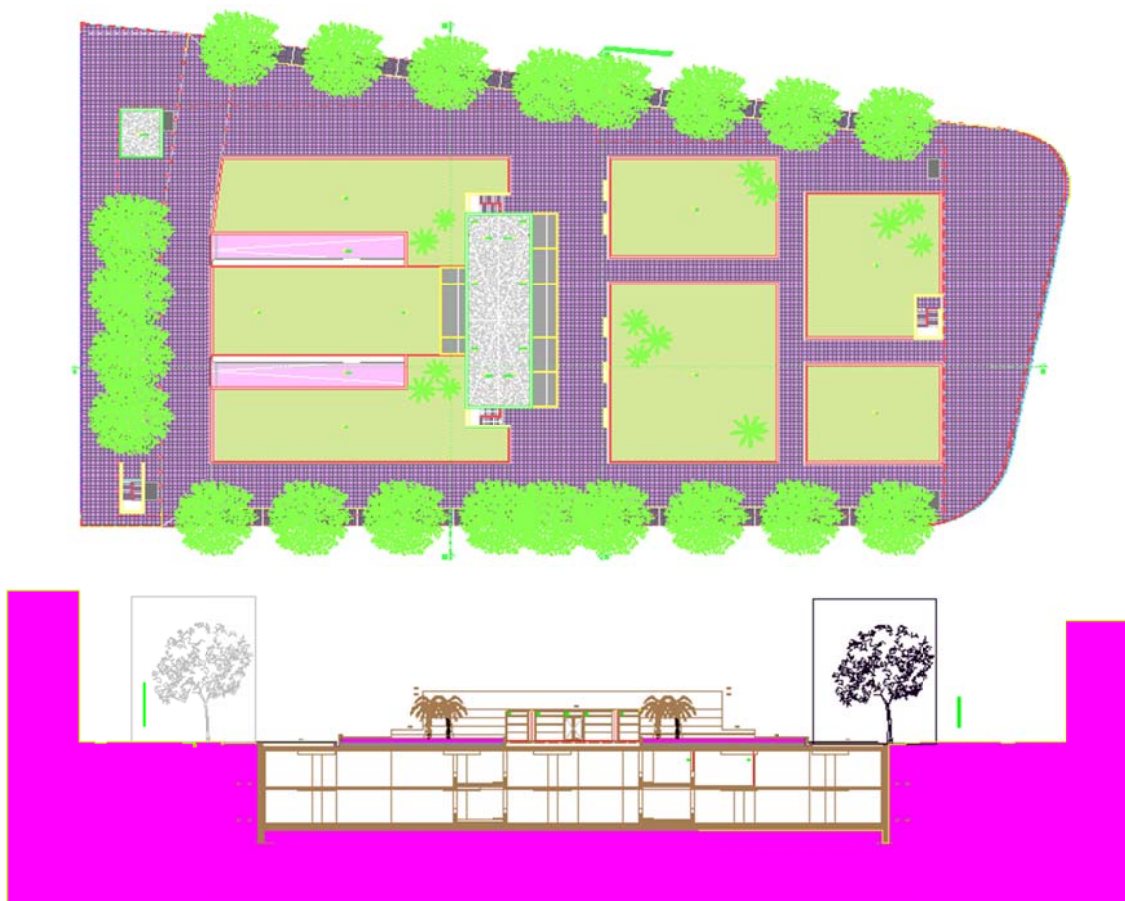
Planta de arranjos exteriores do Parque do Levante – Olhão.
